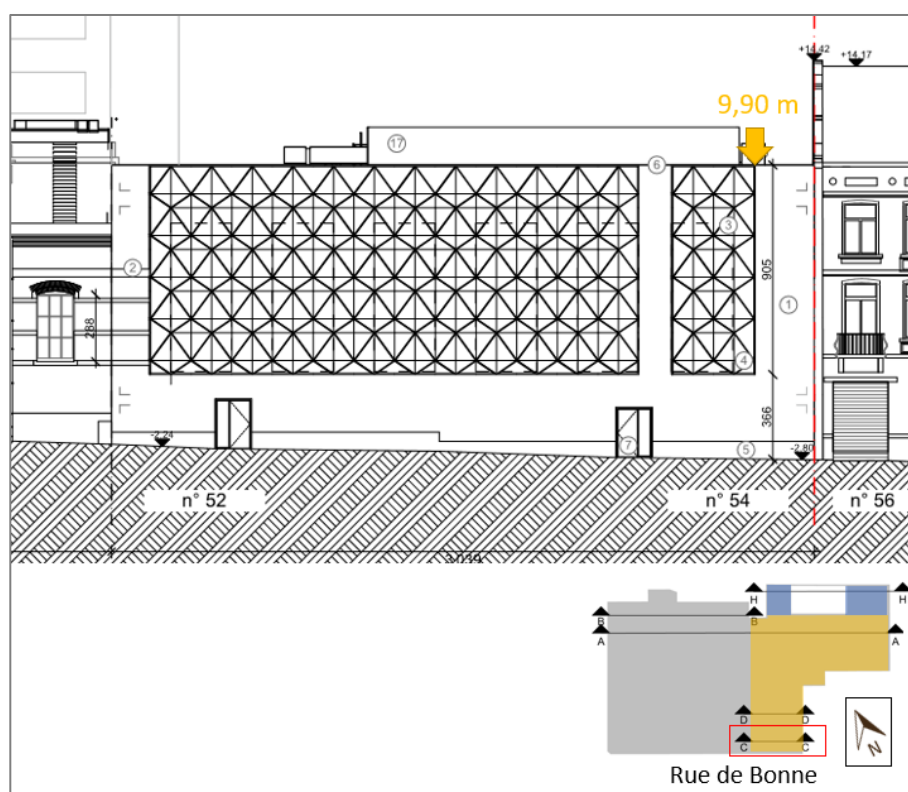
Plan de coupe de l'extension du dépôt vu depuis la rue de Bonne (source : Architecte)
